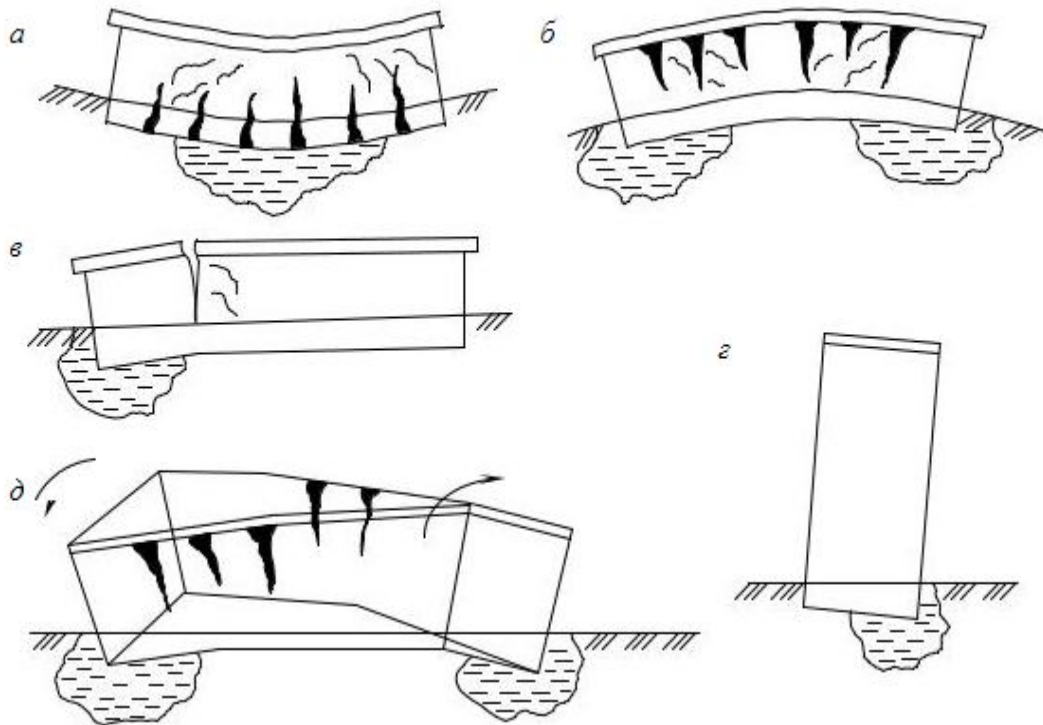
Схеми нерівномірних деформацій будівель залежно від місця замочування основи: а – в середині будівлі; б – під краями будівлі; в – з одного краю; г – під поздовжньою стіною; д – під краями з різних боків
